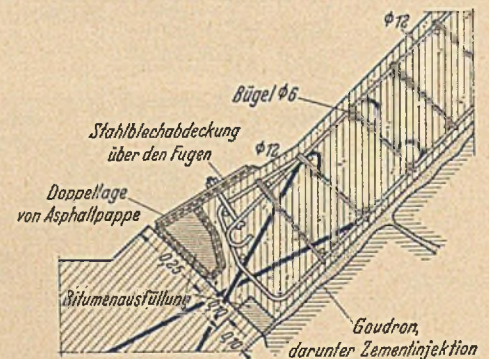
Bakhada-Staudamm. Anschluß der Eisenbetondichtungsdecke an das Widerlager.
